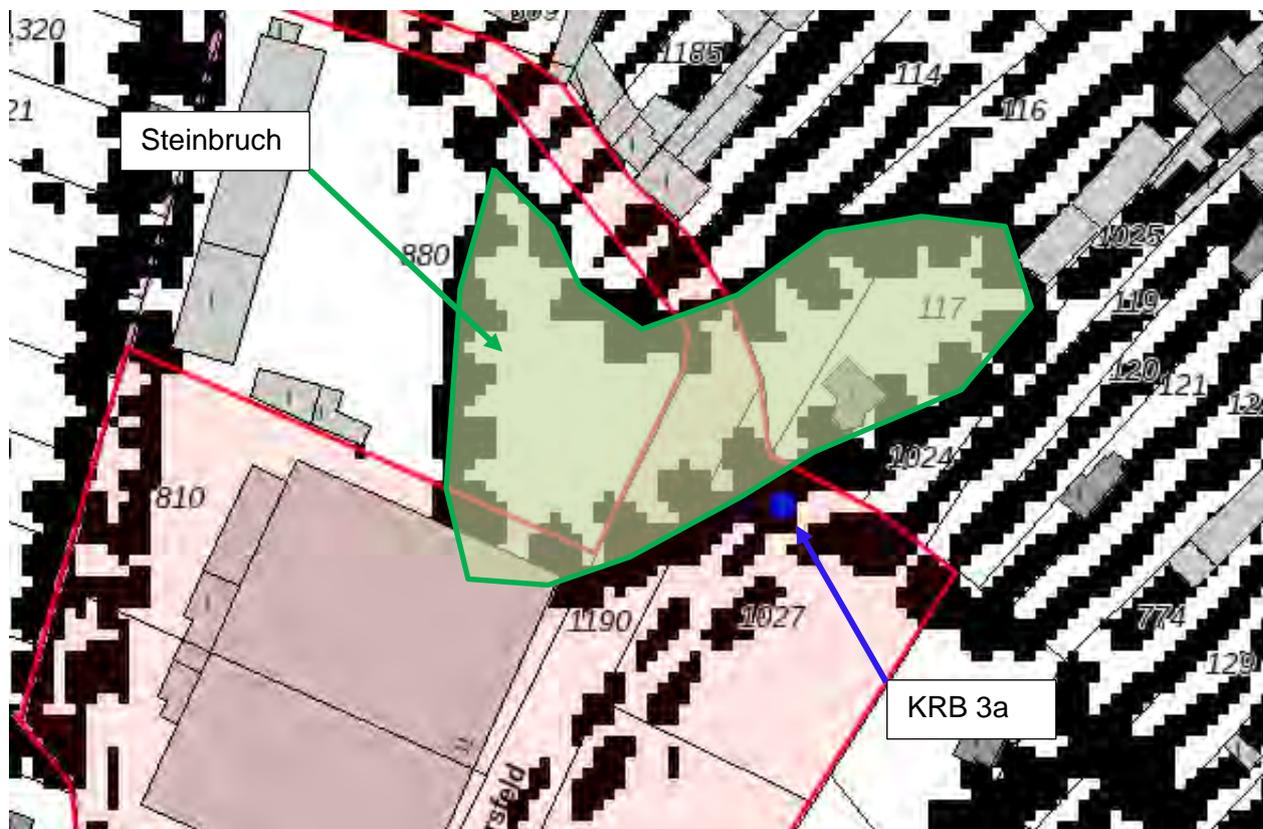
Ausschnitt aus dem Projektbereich (rot) mit Lage der Baugrundbohrung
